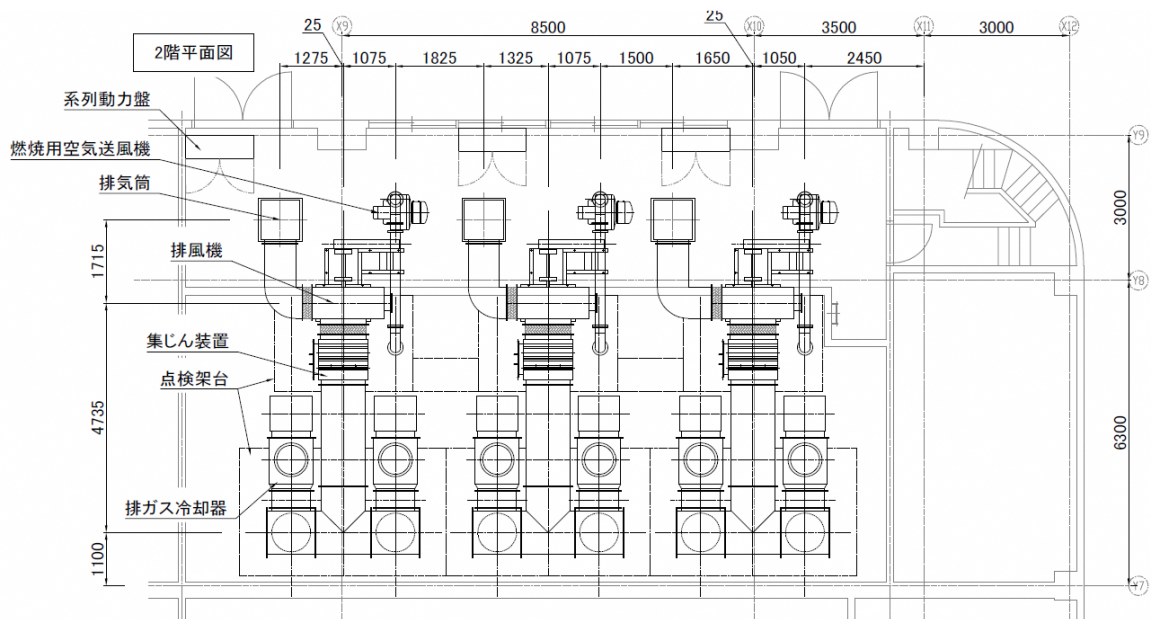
火葬炉 6 基の入替えの場合の火葬炉設備配置例 (2 階平面図)
